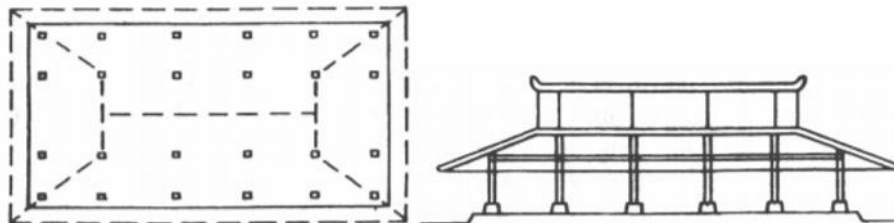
Potongan dan Denah Omah Kampung Srontong
